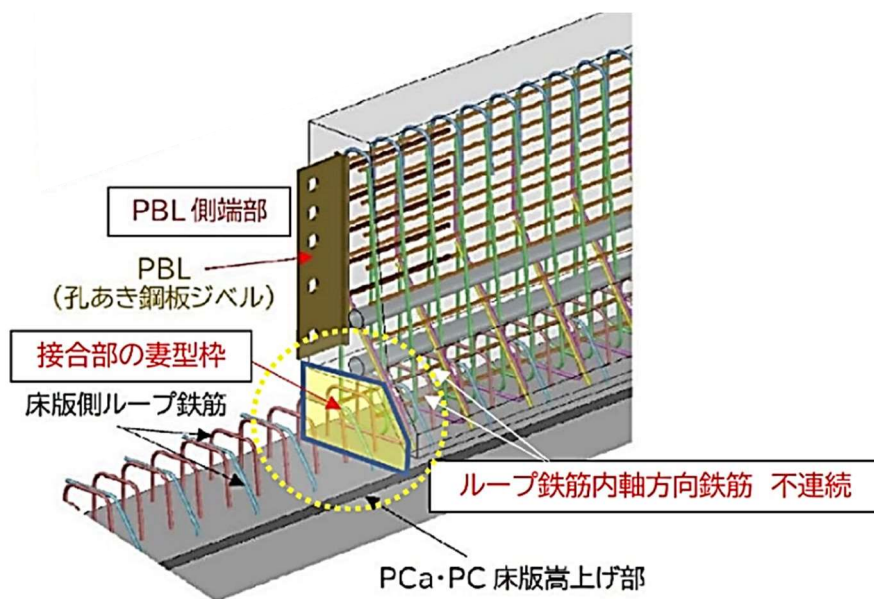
接合部橋軸方向の妻型枠の配置図
